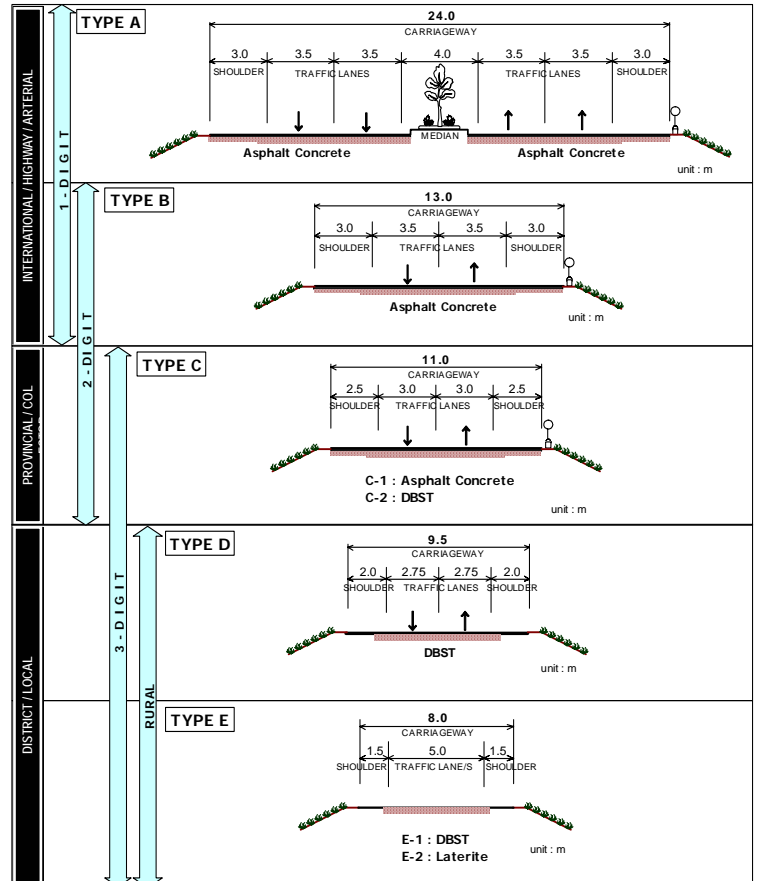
適用道路設計基準 (左) と標準断面図 (右)
